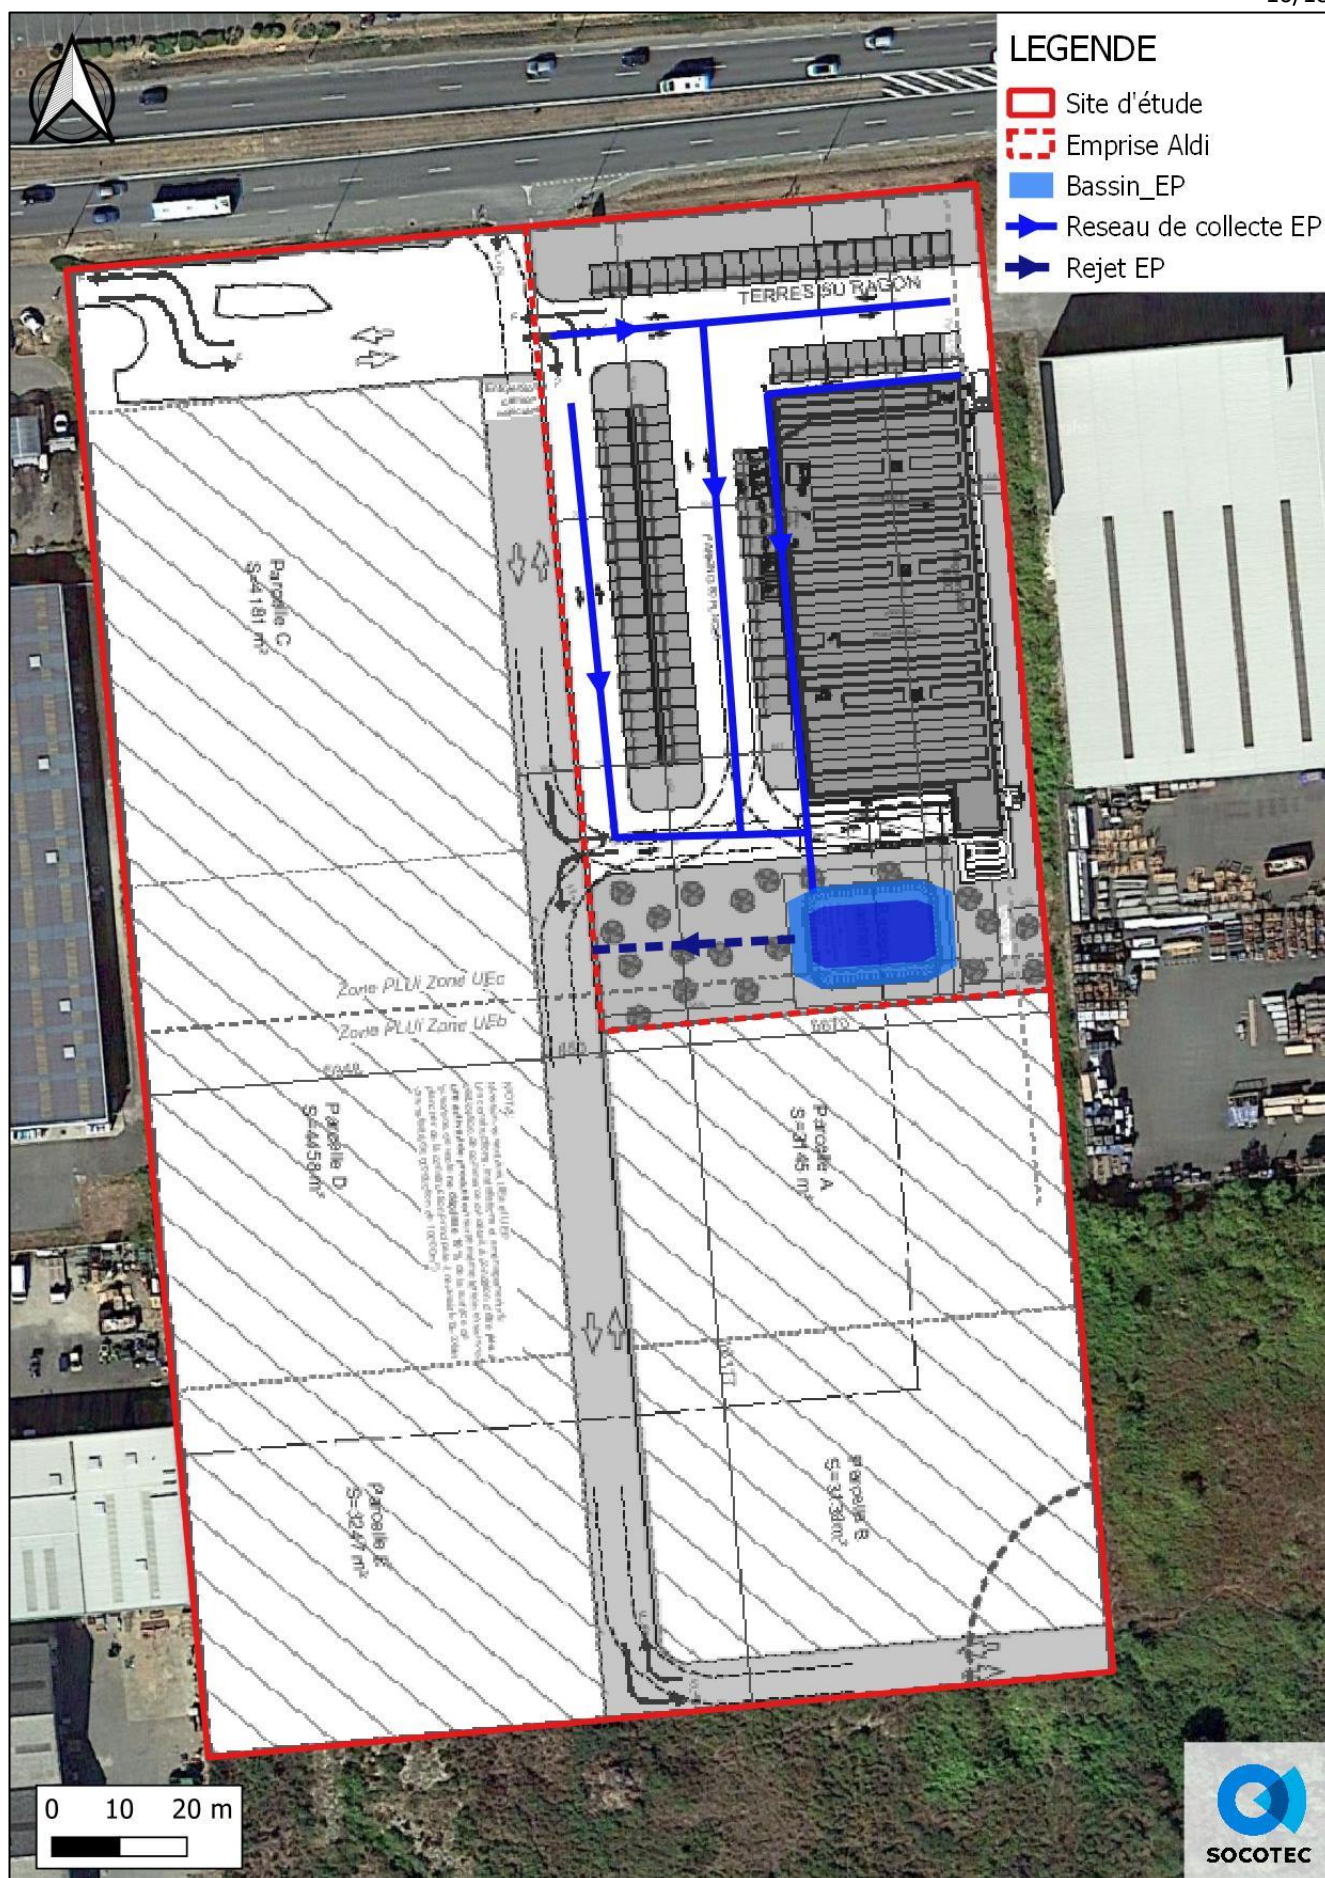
Schéma de principe d'assainissement des eaux pluviales
